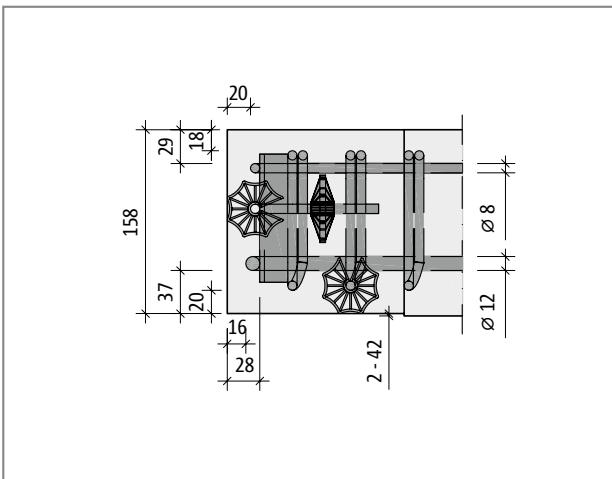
Schöck Tronsole® Typ Z: Seitenansicht einer Betonkonsole mit eingebautem Tragelement
